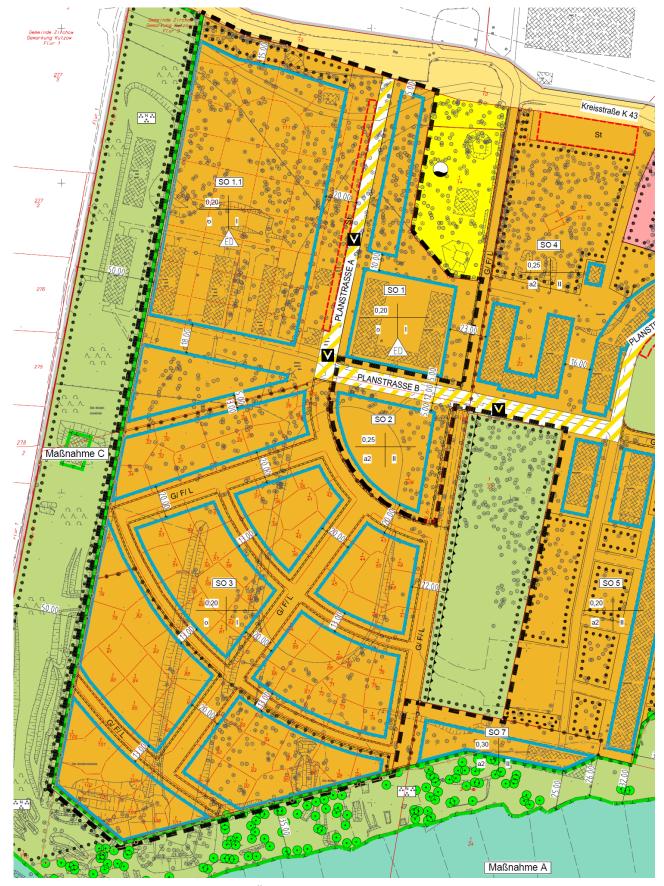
Planzeichnung, Stand 1. Änderung, Ausschnitt mit SO 1, 1.1 und 3 ohne Maßstab
